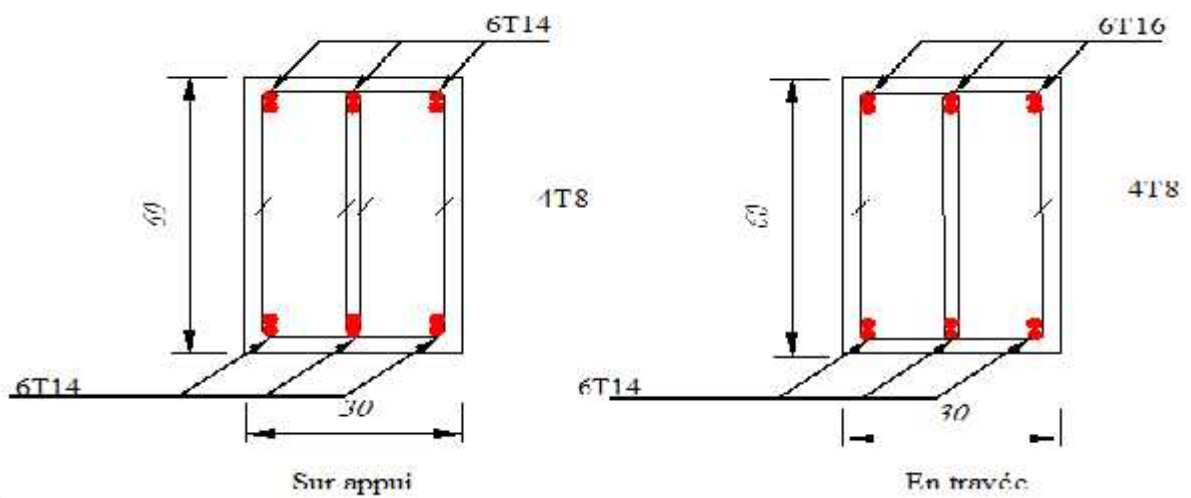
Ferraillage des poutres porteuses quatrièmes types.
